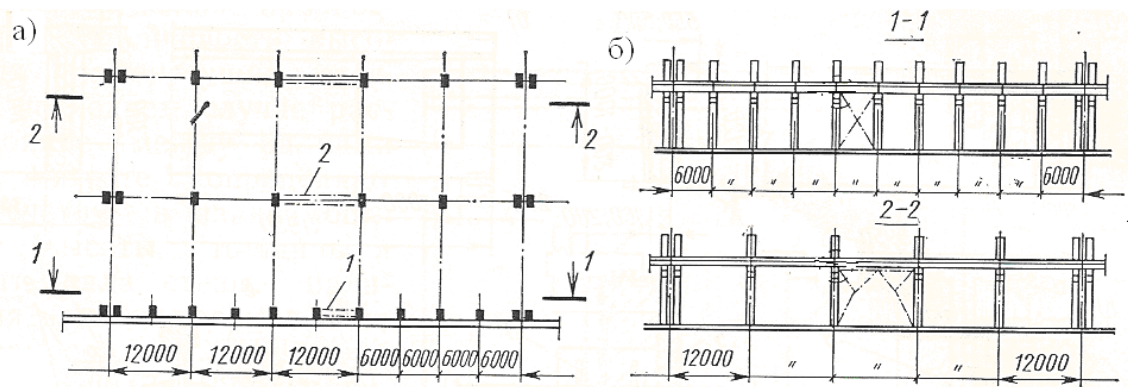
Вертикальные связи между железобетонными колоннами: а) - схема связей по колоннам на плане здания; б) - то же, на разрезах здания; 1- крестовые связи; 2- порталные связи
